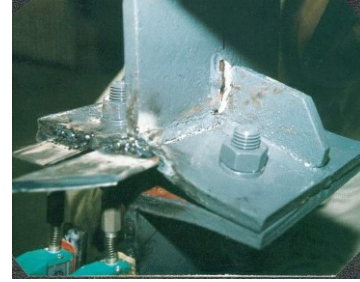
Rupture du cordon de soudure-tp=10mm
